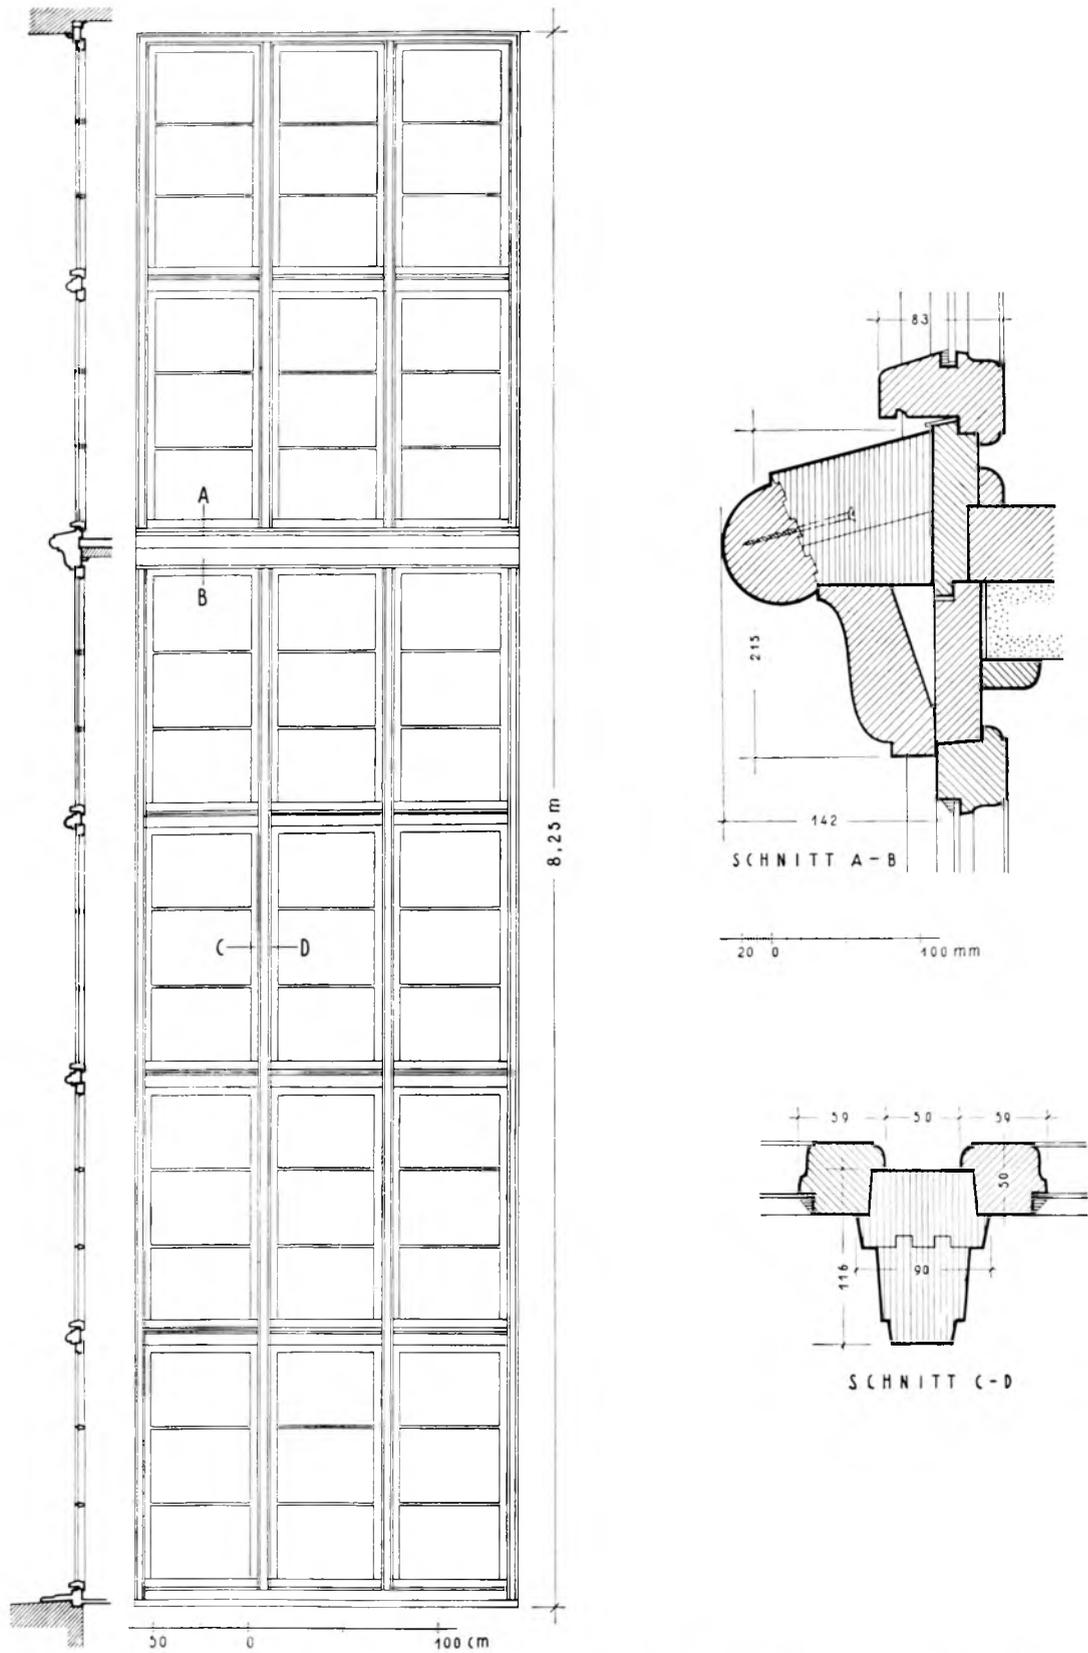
18flügeliges Fenster in Kiefernholz des Erdgeschosses und des I. Obergeschosses
